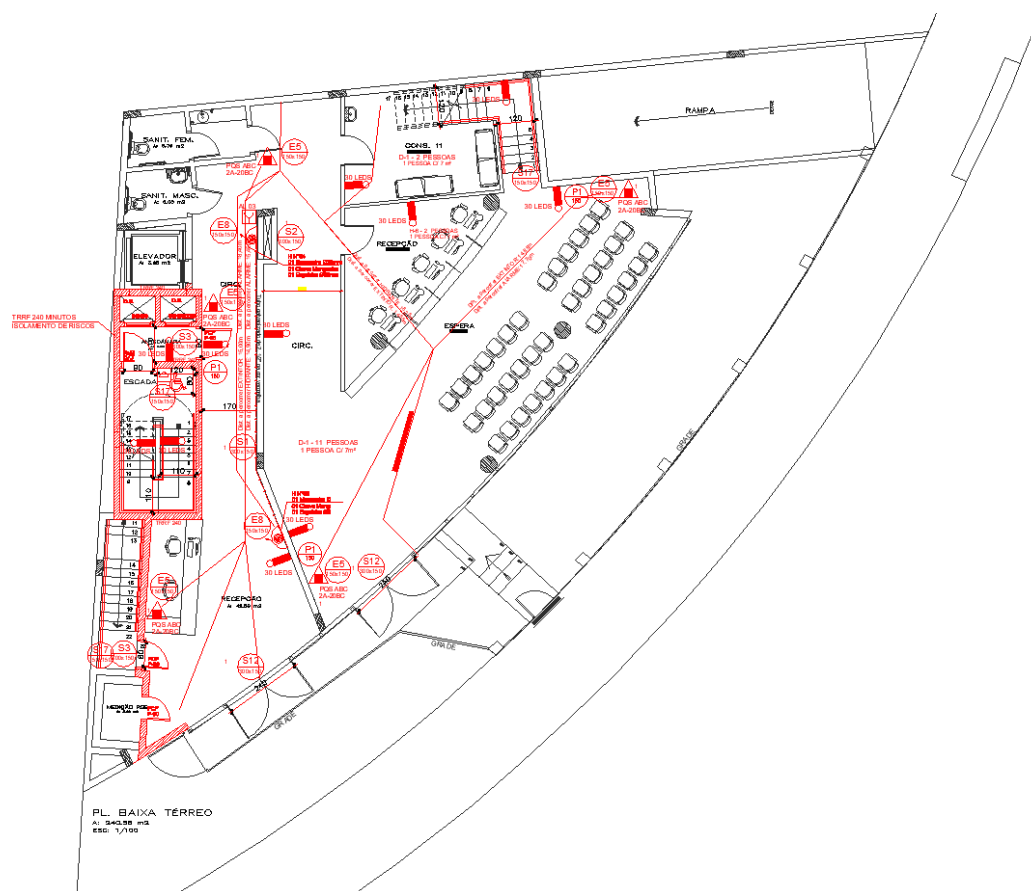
Planta baixa PPCI – Pavimento Térreo - Centro Municipal de Saúde
